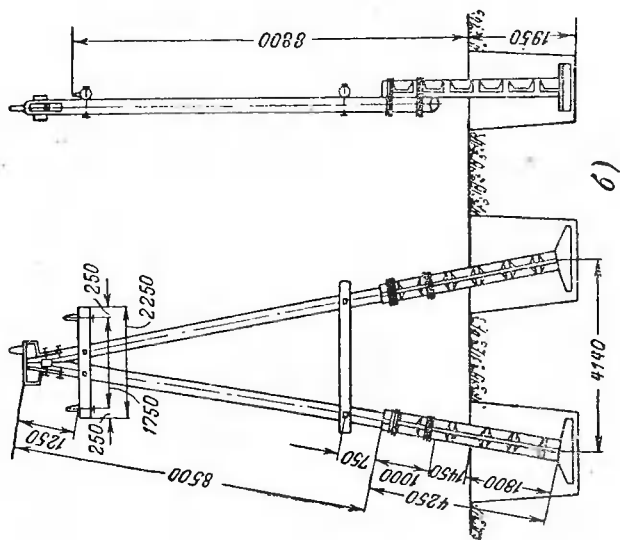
Железобетонные опоры для проводов ПСО-4—ПСО-5, ПС-25, А-25—А-70, АС-16—АС-35.
